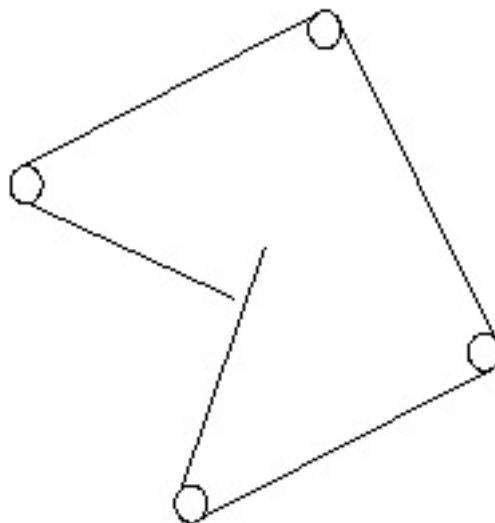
Staffe di stabilizzazione delle barre longitudinali.
